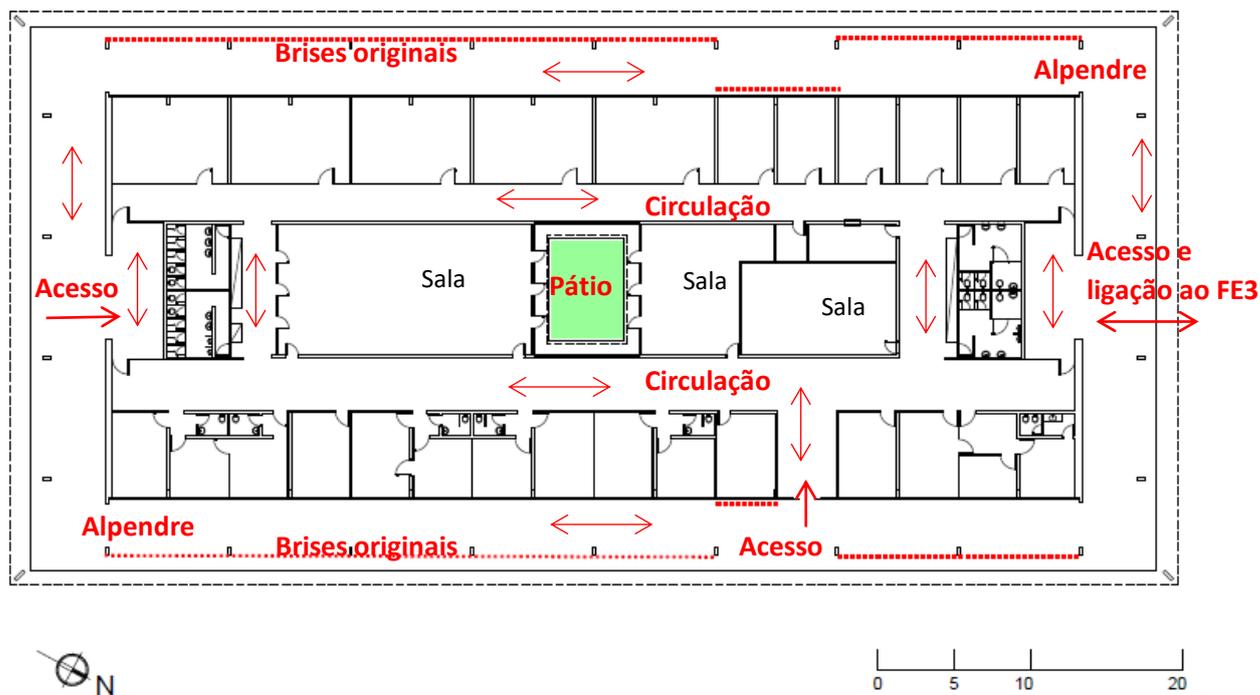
Planta baixa FE1. Fonte: Prefeitura do *campus*, 2010 (adaptado pela autora)
